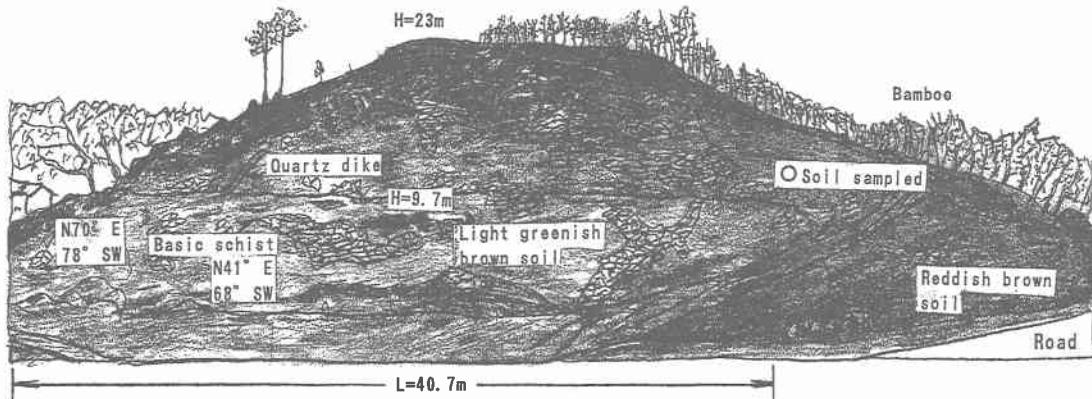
切土斜面の地質断面図と土試料(No. 1)採取位置
